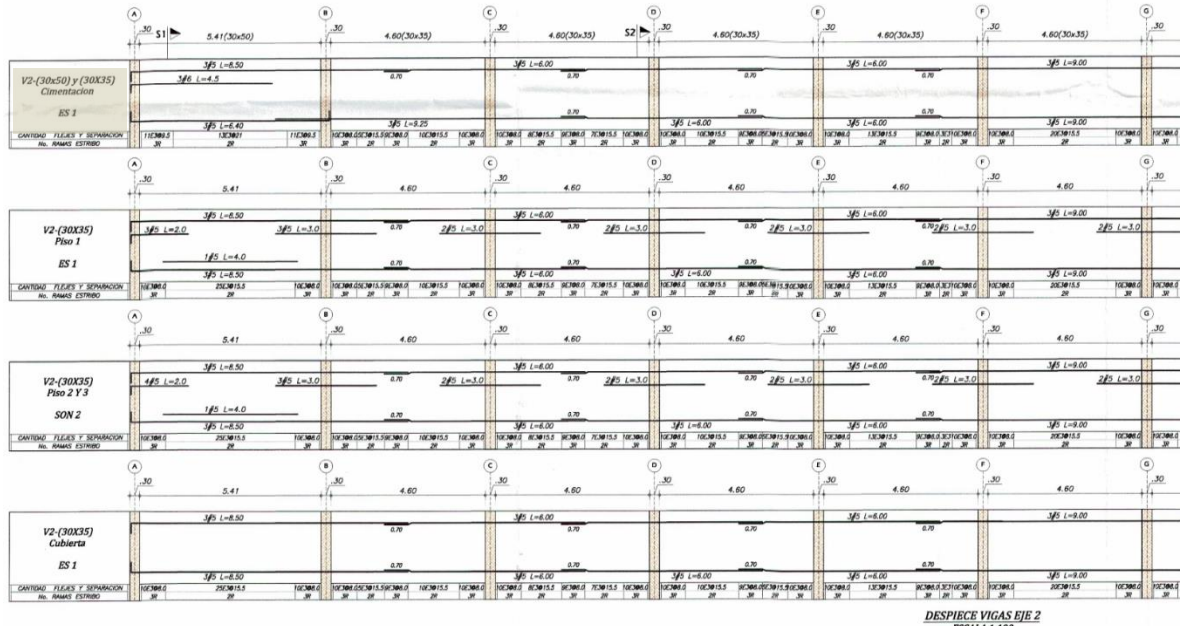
Detalles Constructivos Vigas Transversales - Ejes 1 – 2 – 3 – 4.
